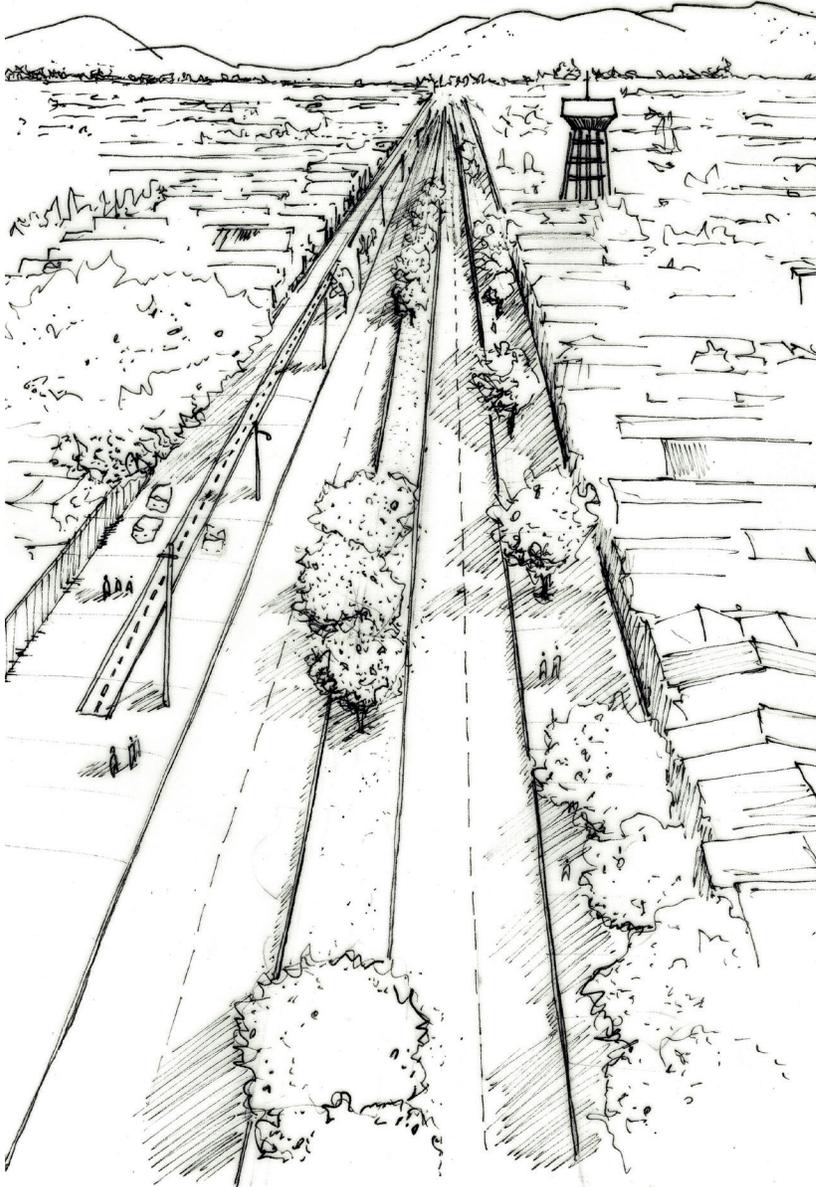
Croquis vista aérea Avenida Padre Hurtado
